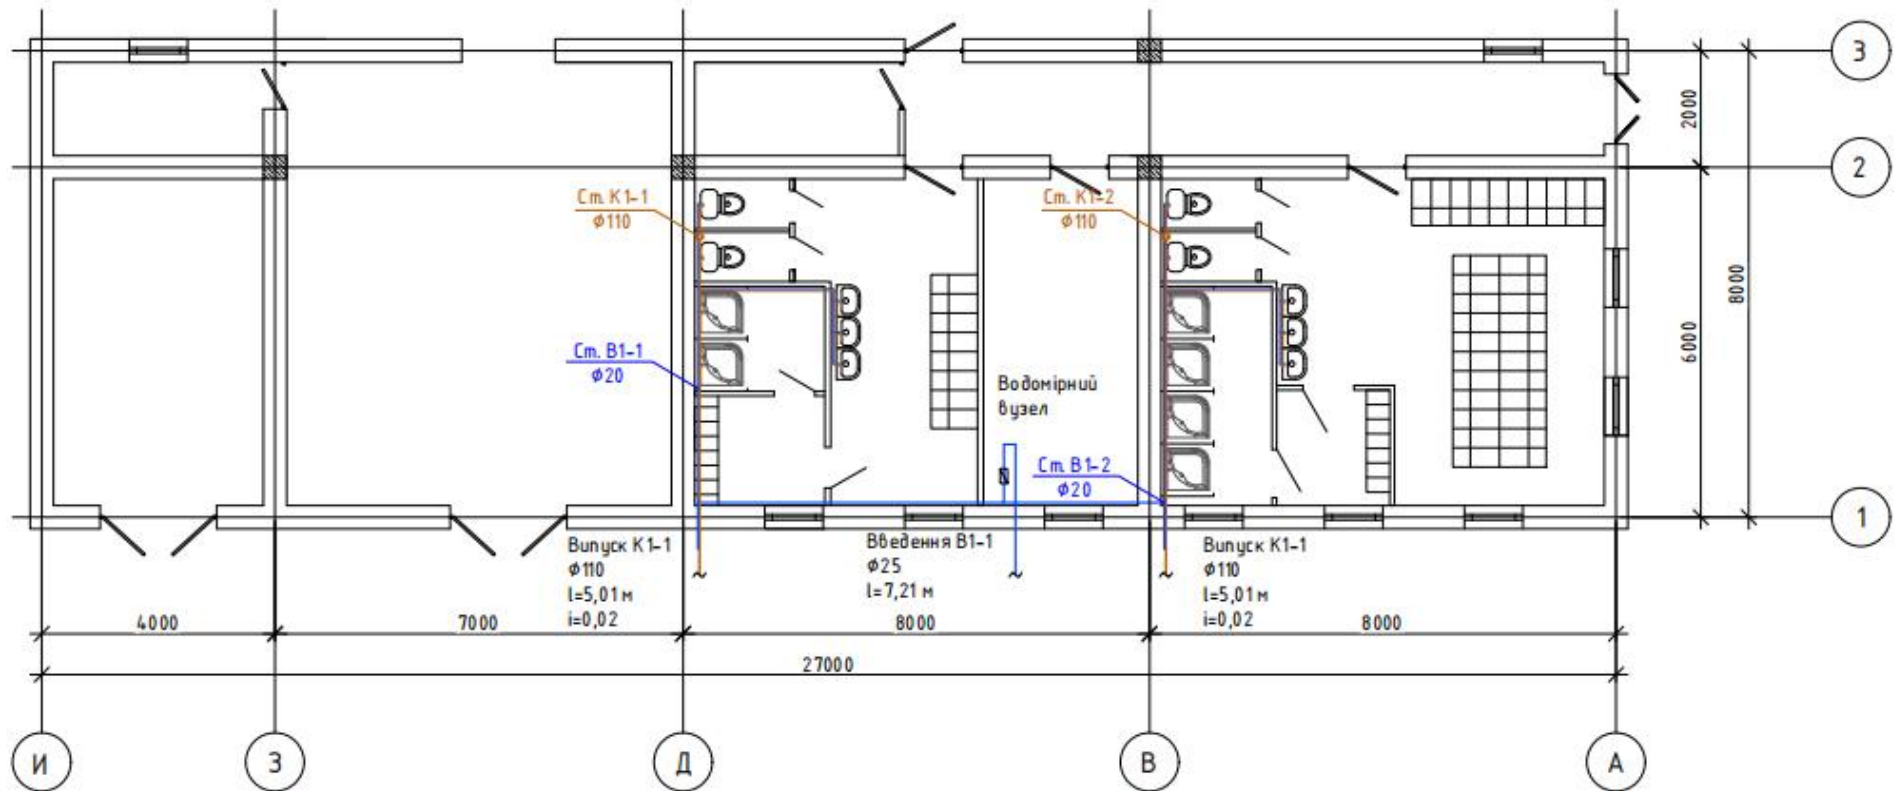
Розрахункова схема трубопроводу холодного водопостачання
